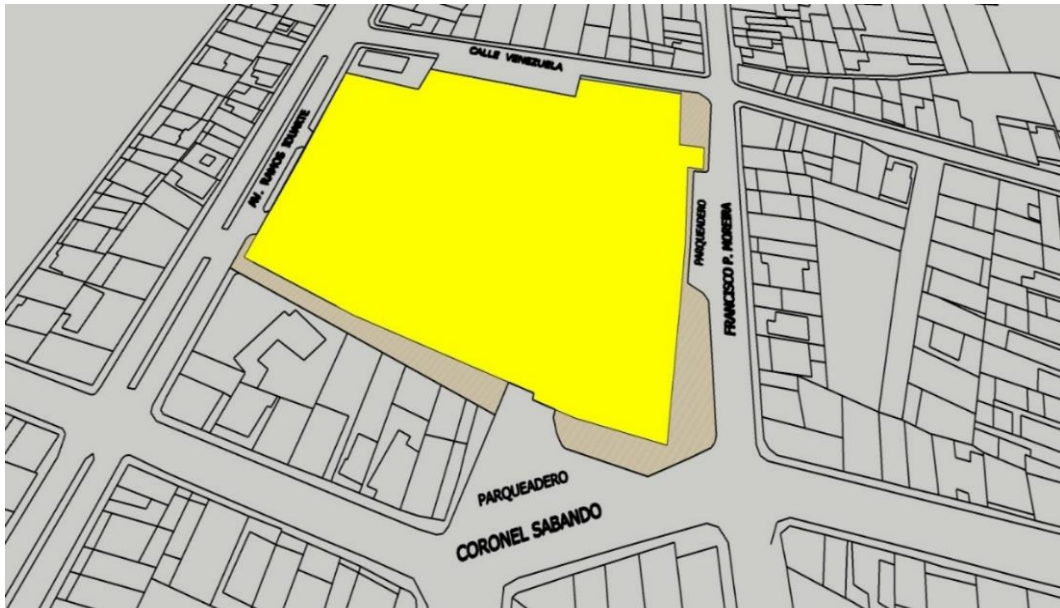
, Esquema de la ubicación del terreno donde se planteará la nueva propuesta del mercado N° 2 de Portoviejo.
